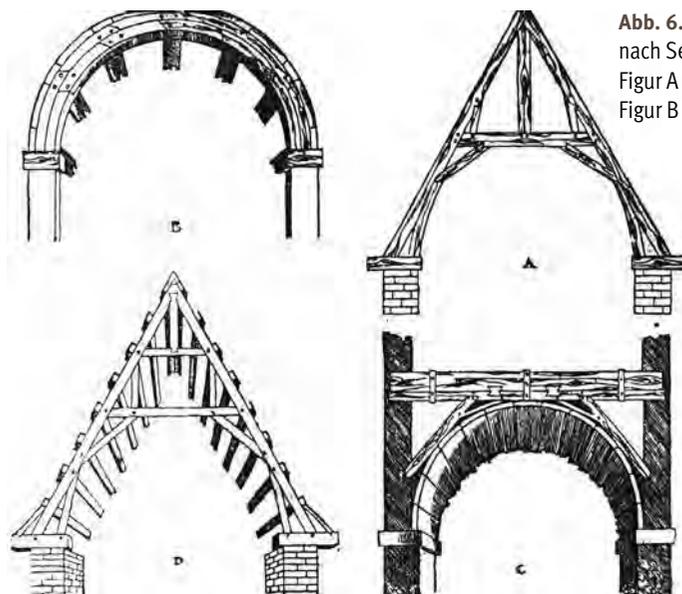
Dachkonstruktionen nach Serlio, aus /26/ Figur A und D: Kehlbalkendächer; Figur B und C: Bohlenbögen
